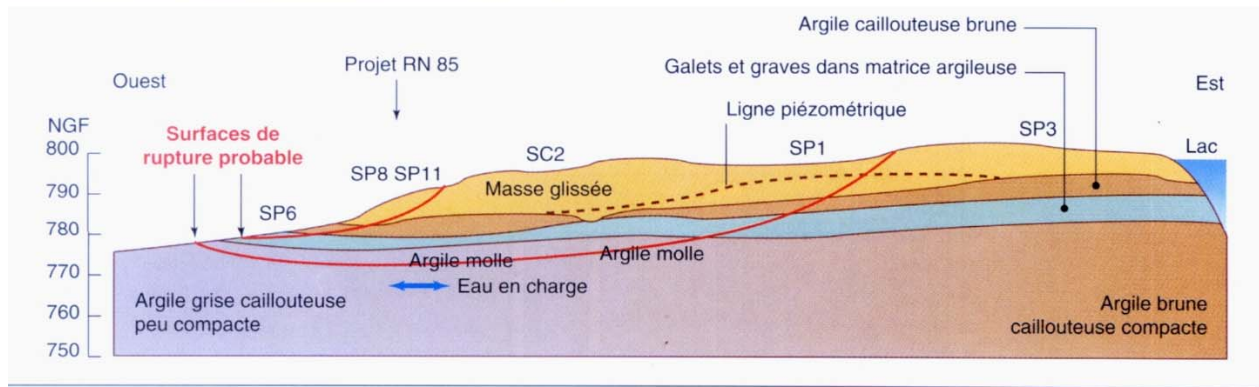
La Salle-en-Beaumont. État de la masse glissée avant les travaux de drainage et de terrassement. Coupe A-B (Ouest-Est).
